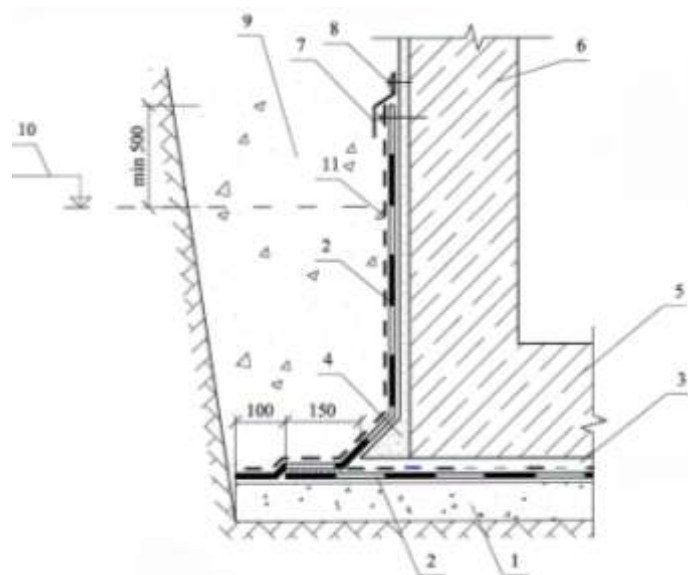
Гидроизоляция тоннеля при наличии грунтовых вод
